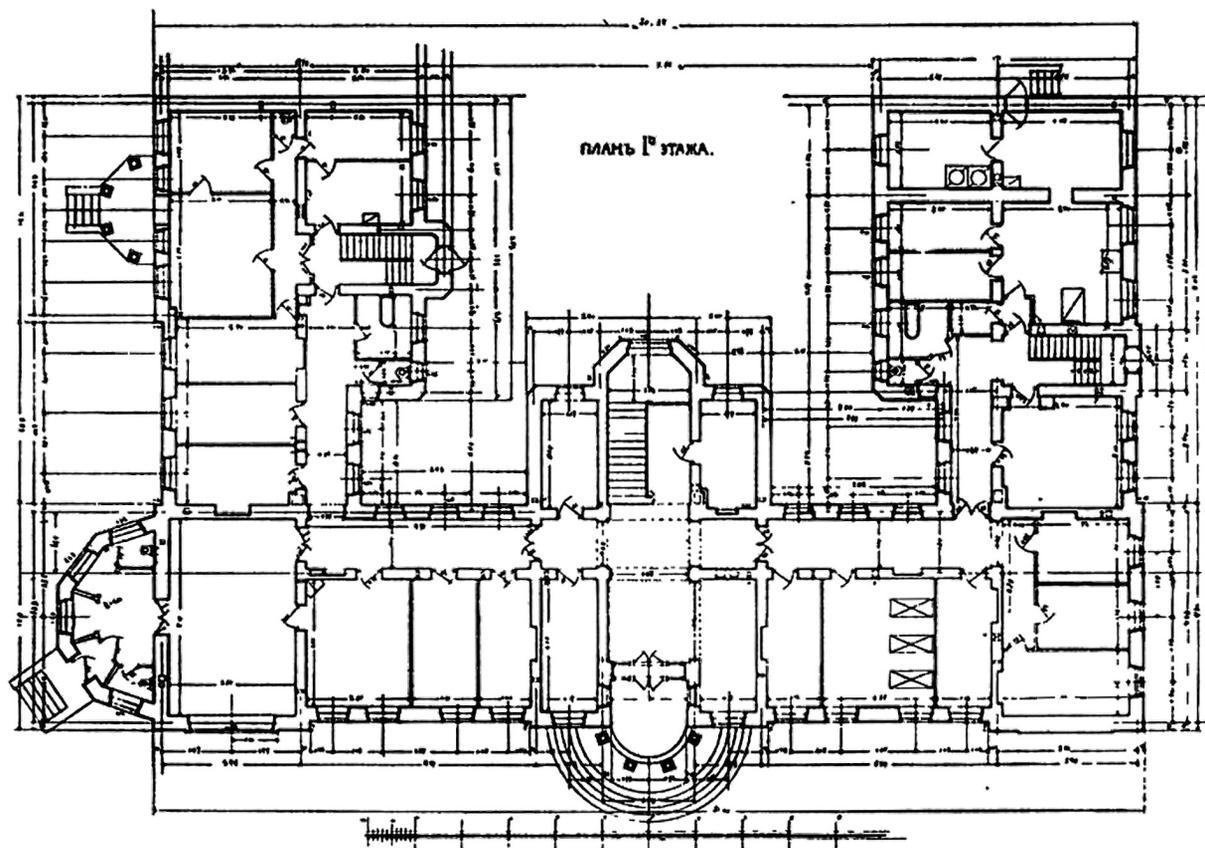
Здание больницы В.Б. Перовской для бедных. План первого этажа [32]
